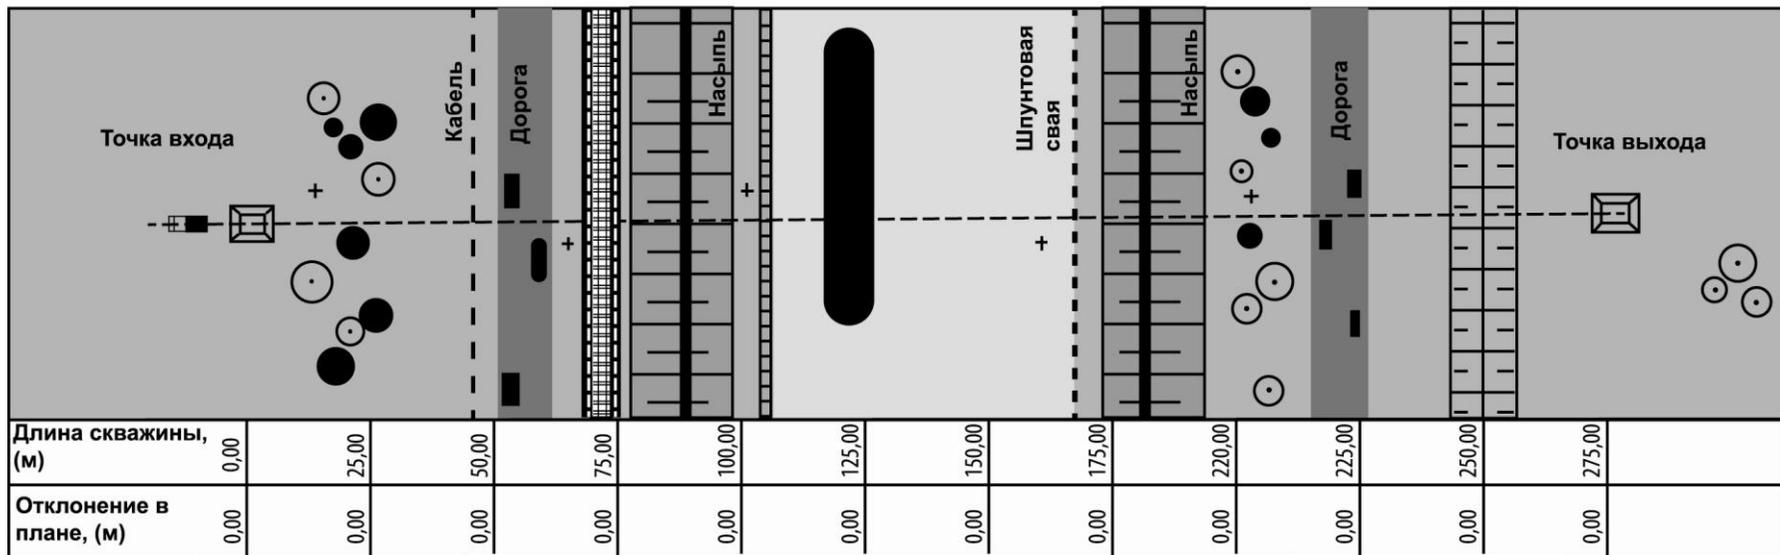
Схема продольного профиля и плана закрытого подземного перехода, сооружаемого методом ГНБ
